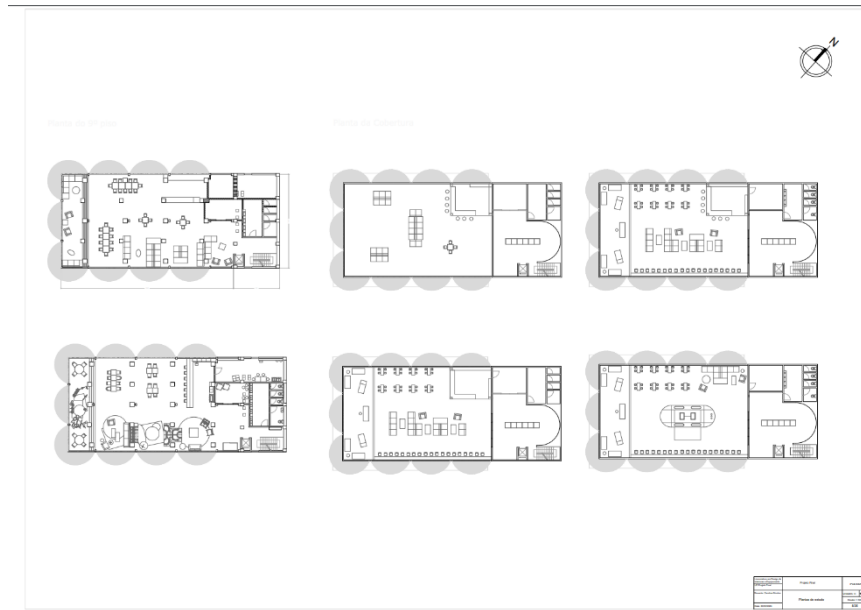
Desenho técnico de plantas de estudo - Piso 9 e Cobertura, respetivamente
